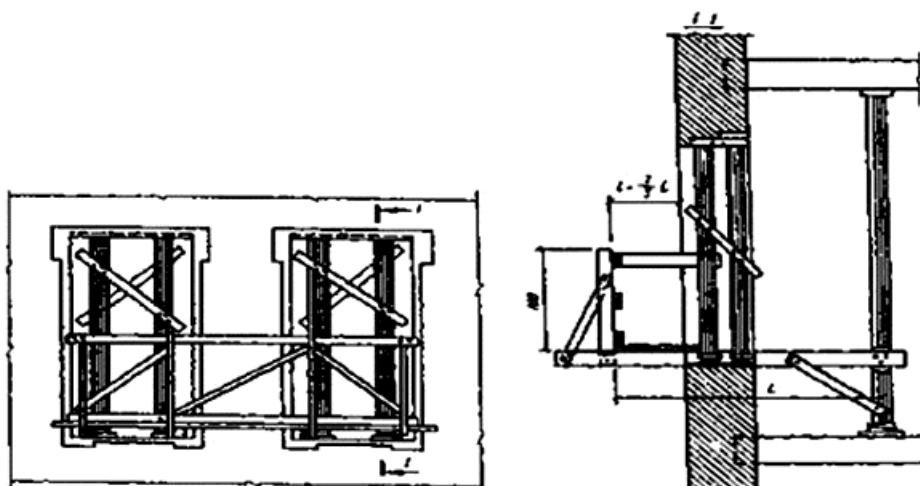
Схема устройства временных креплений перемычек и выпускных лесов при усилении кирпичных простенков
